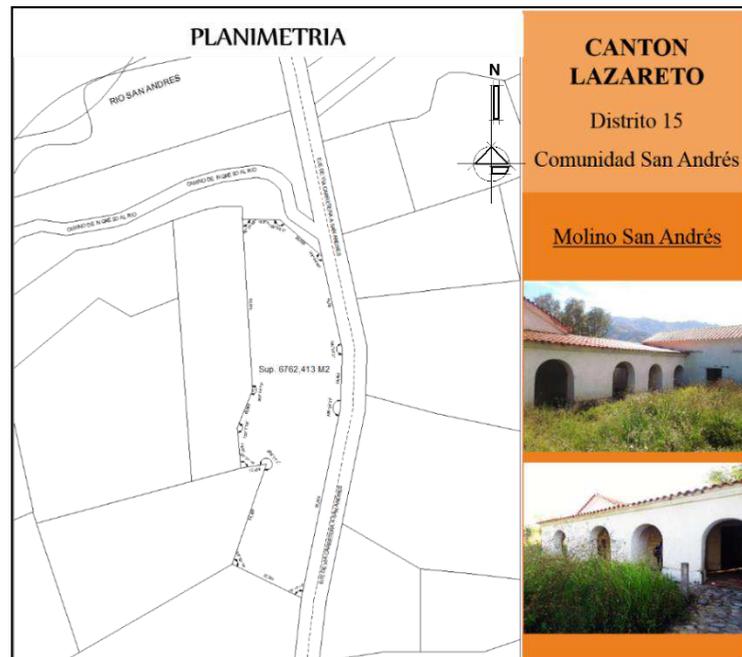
Planimetría del proyecto. San Andrés.
